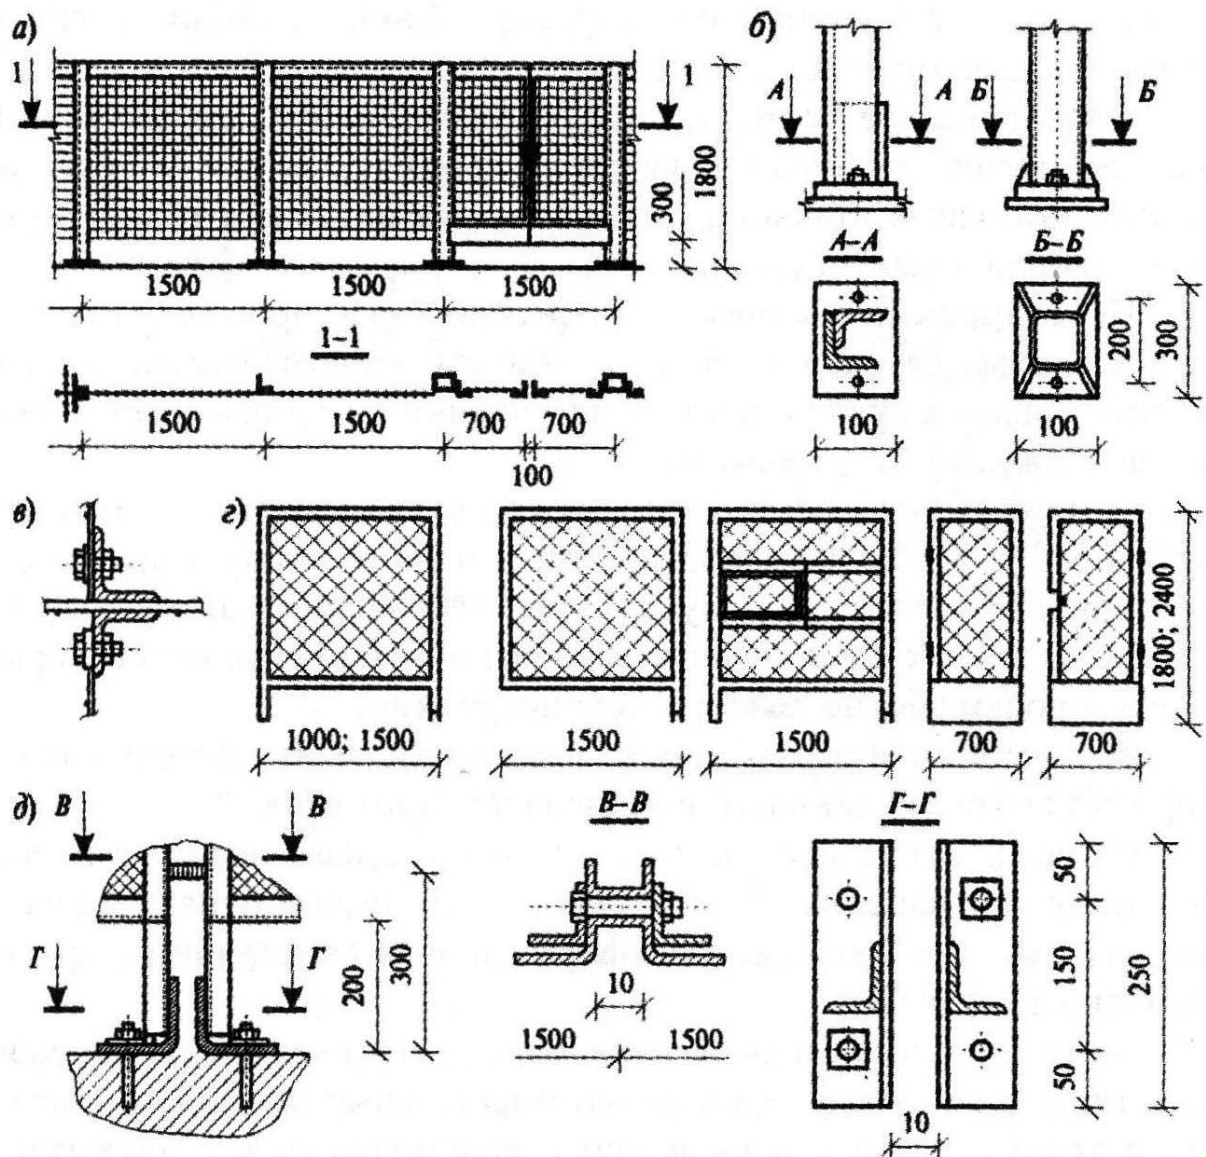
Выгораживающие перегородки из стальной сетки:
